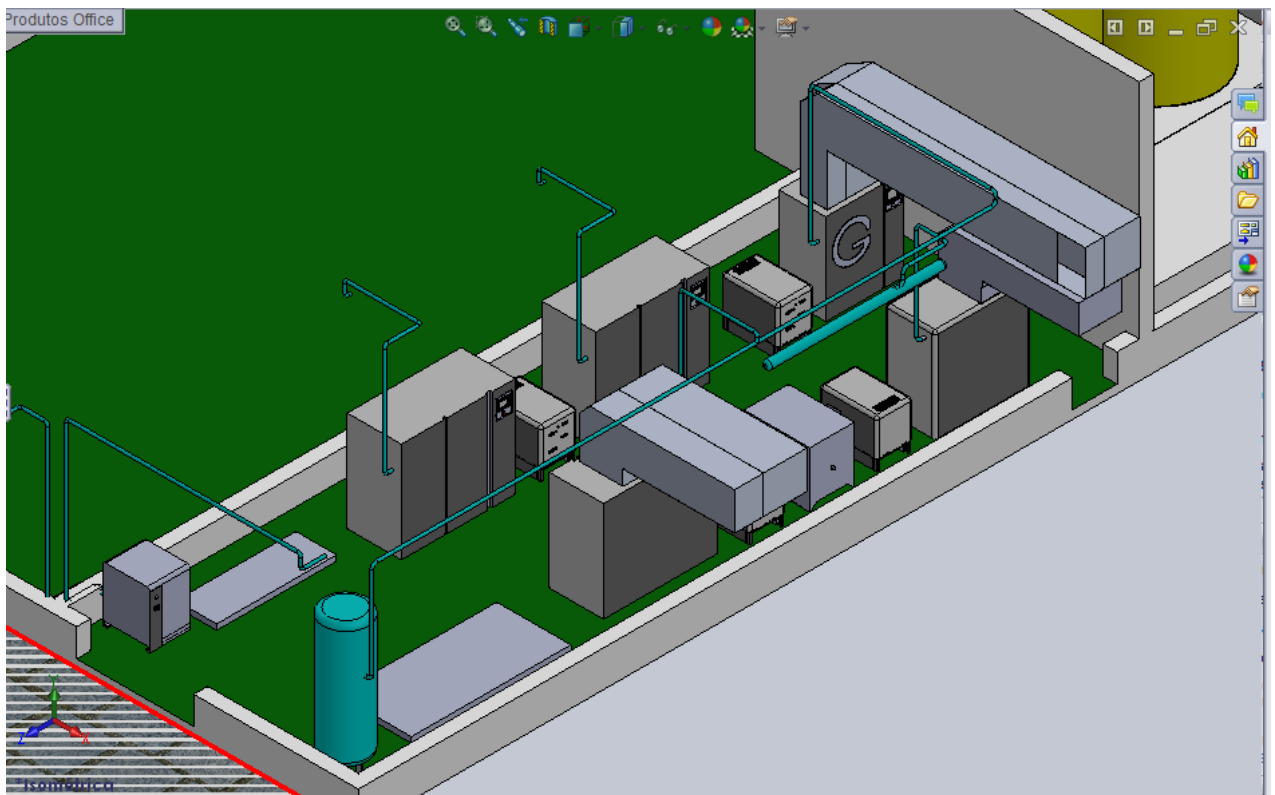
Layout da Sala de Geração de Ar Comprimido.
